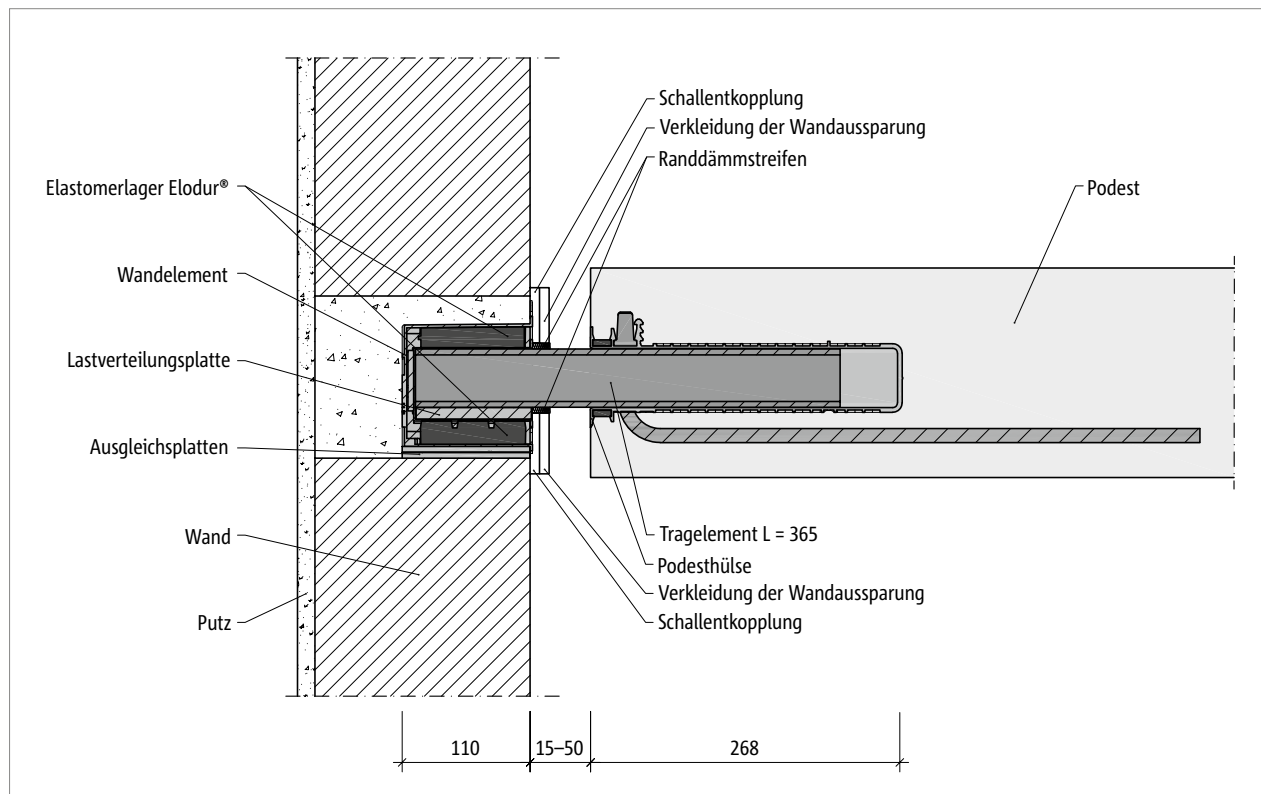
Tronsole® P: Einbauschnitt mit Fertigteilpodest und Luftfuge
